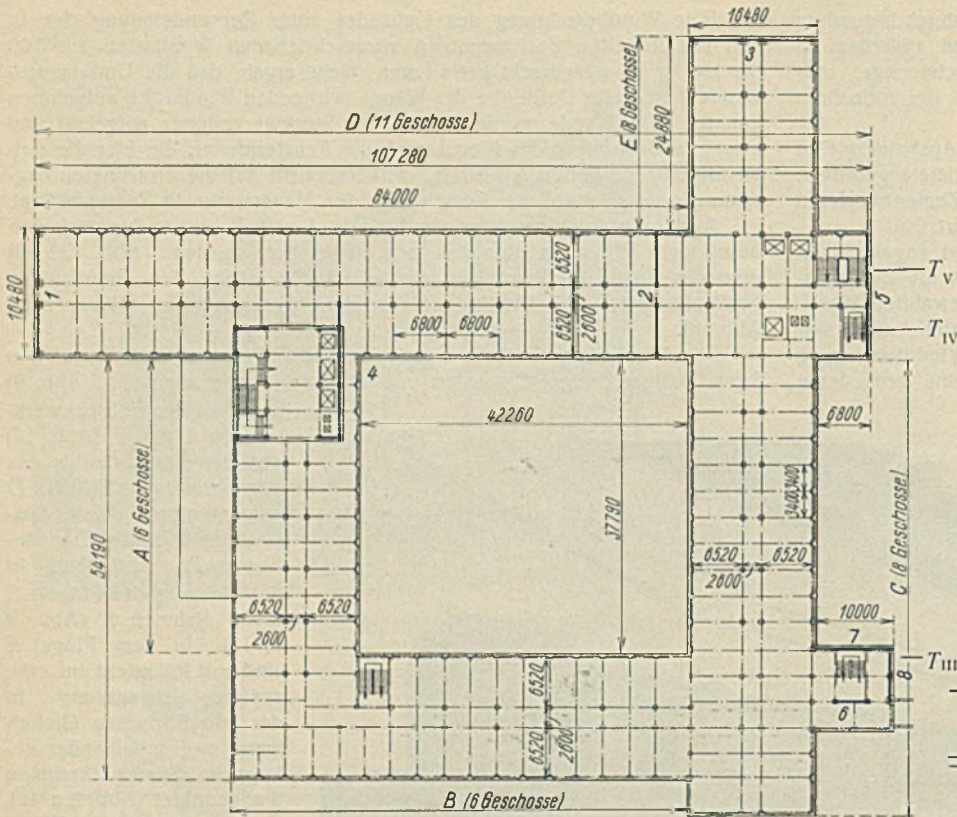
Grundriß des Wernerwerks in Siemensstadt.
